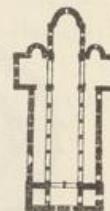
Grundriss Klosterkirche Hedingen.
